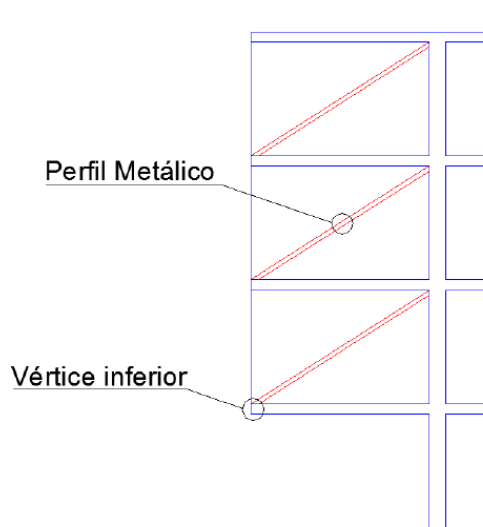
Solução com perfil metálico na diagonal da parede de alvenaria [10]
